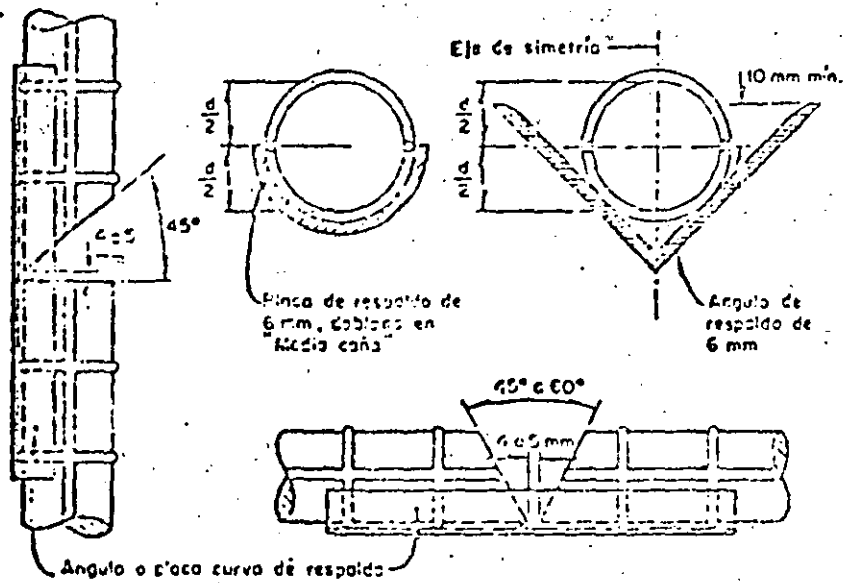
JUNTAS CON PLACA O ANGULO DE RESPALDO
